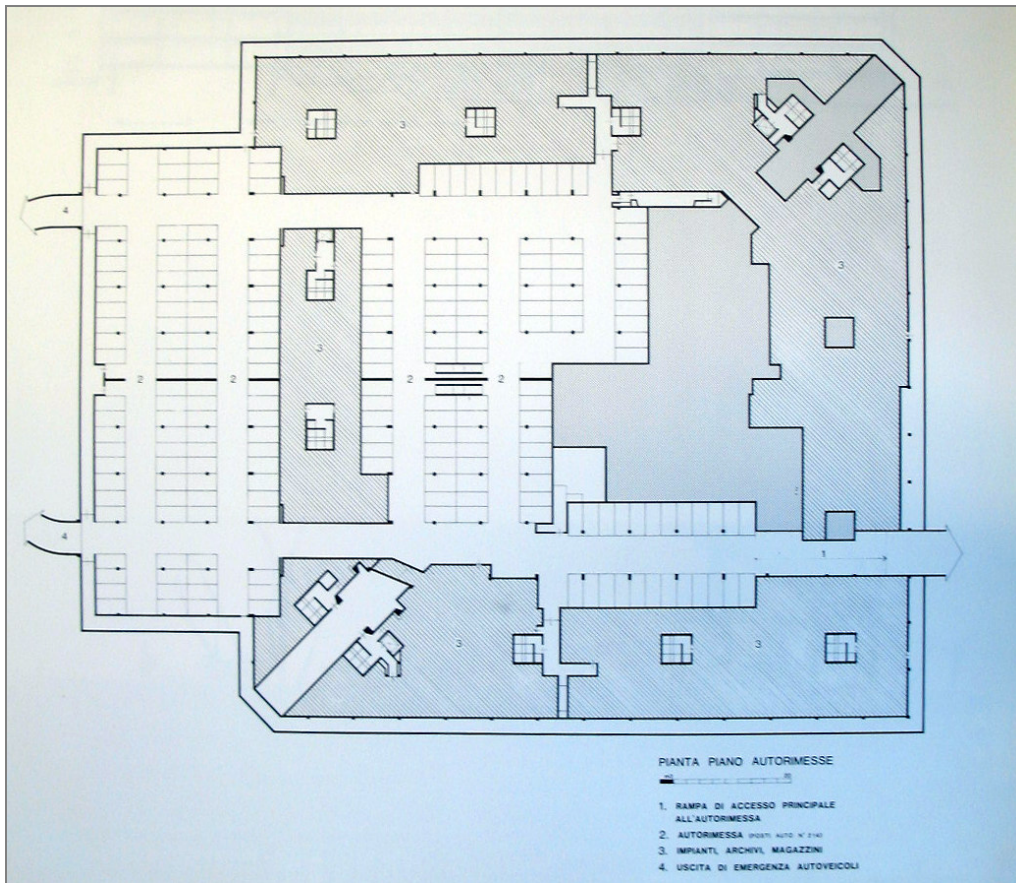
pianta del piano autorimesse (archivio studio alberti matti ferrari)
